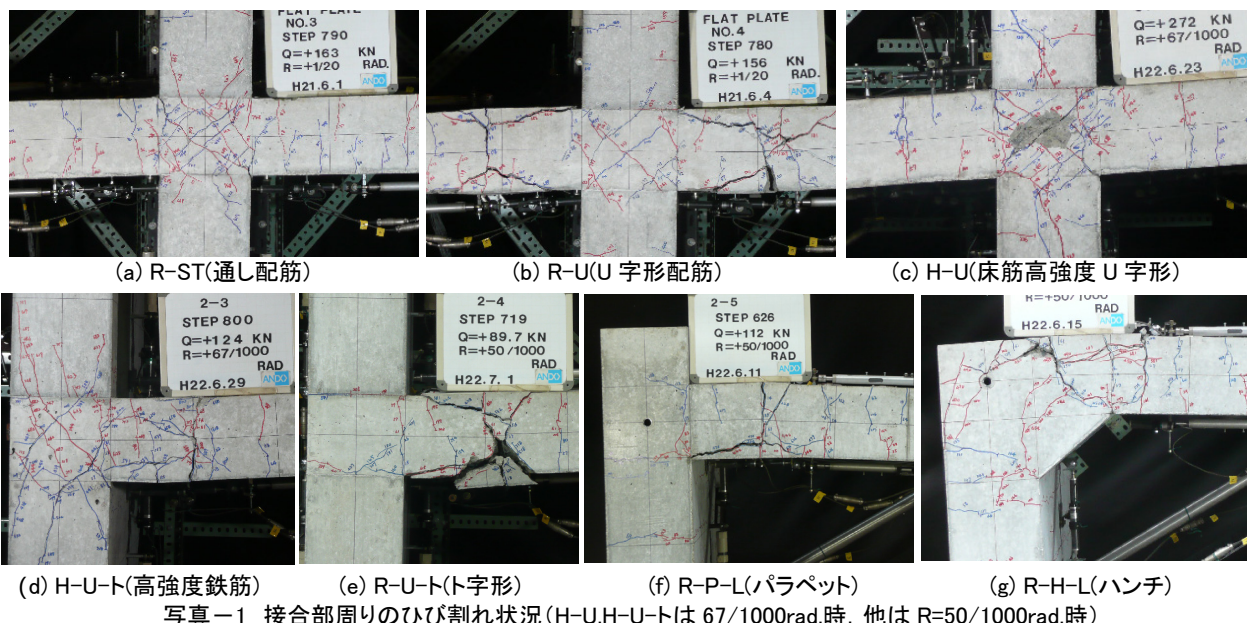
接合部周りのひび割れ状況 (H-U, H-U-Tは 67/1000rad.時, 他は R=50/1000rad.時)
